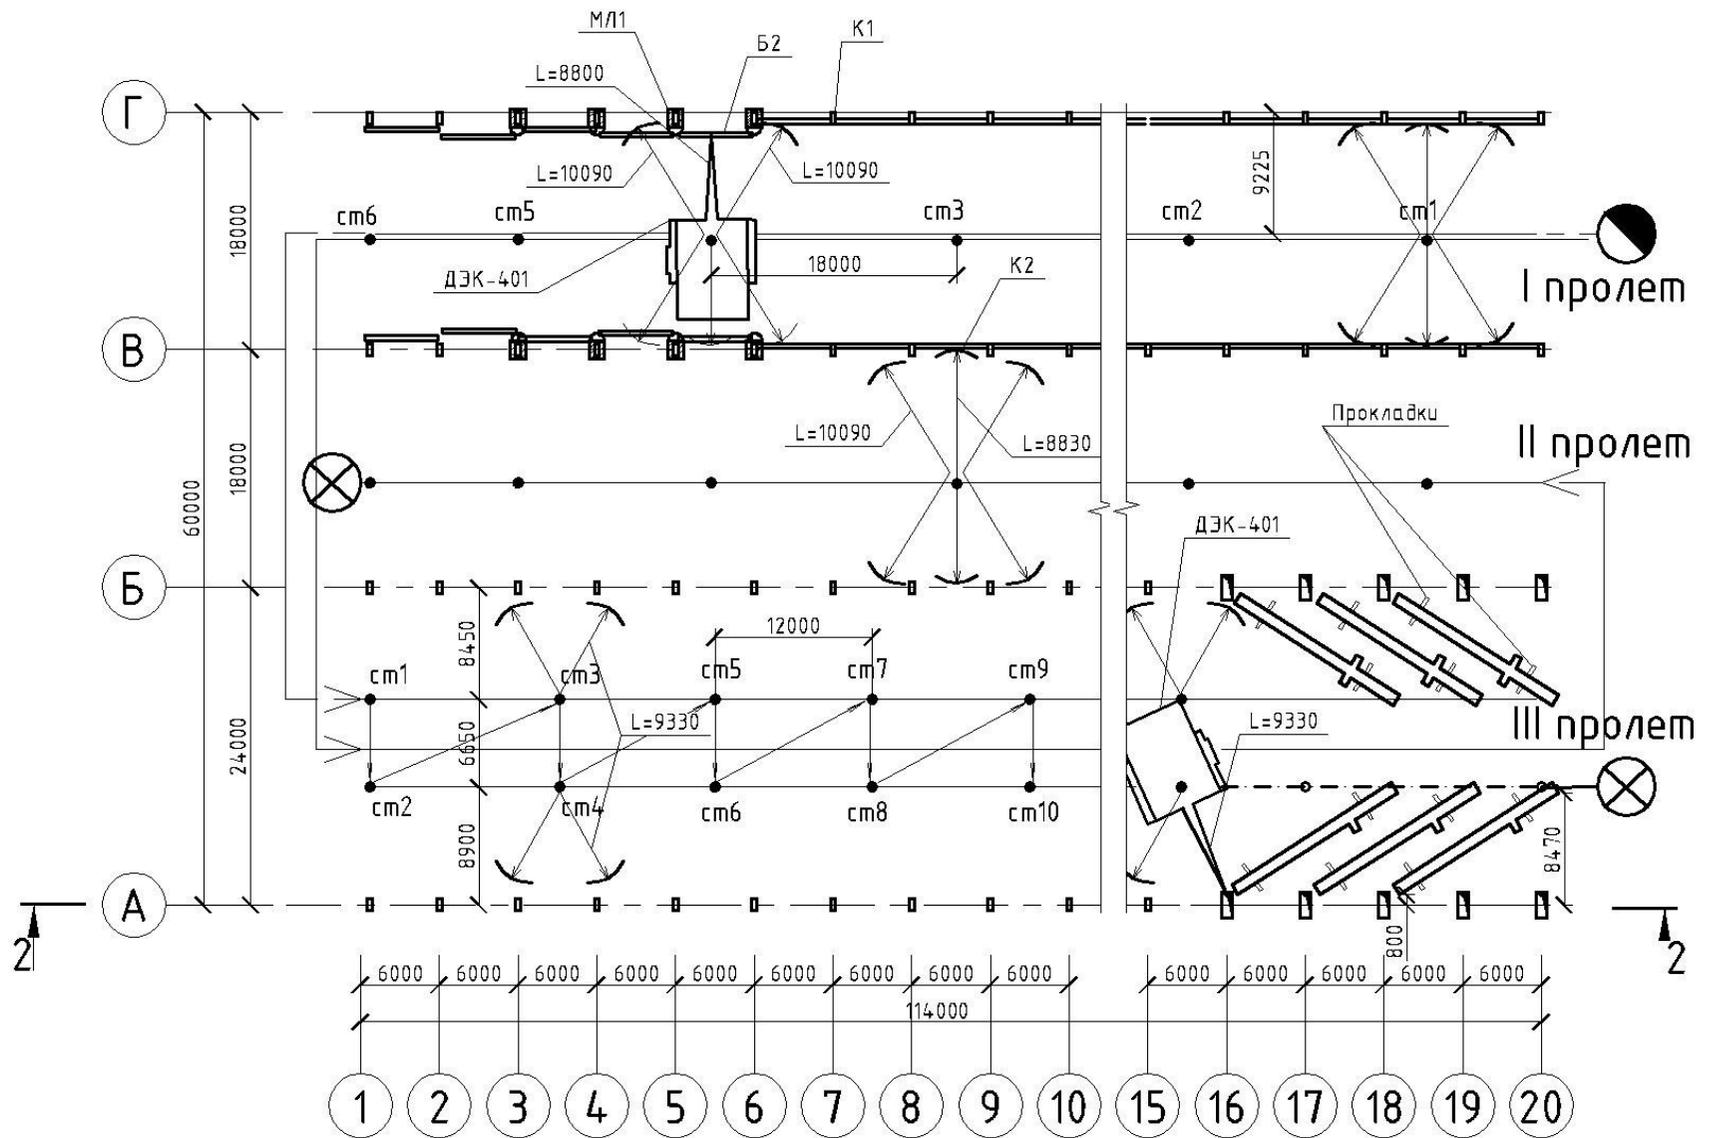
Общая схема с фрагментами последовательного монтажа отдельных элементов каркаса при занятости одного монтажного крана
